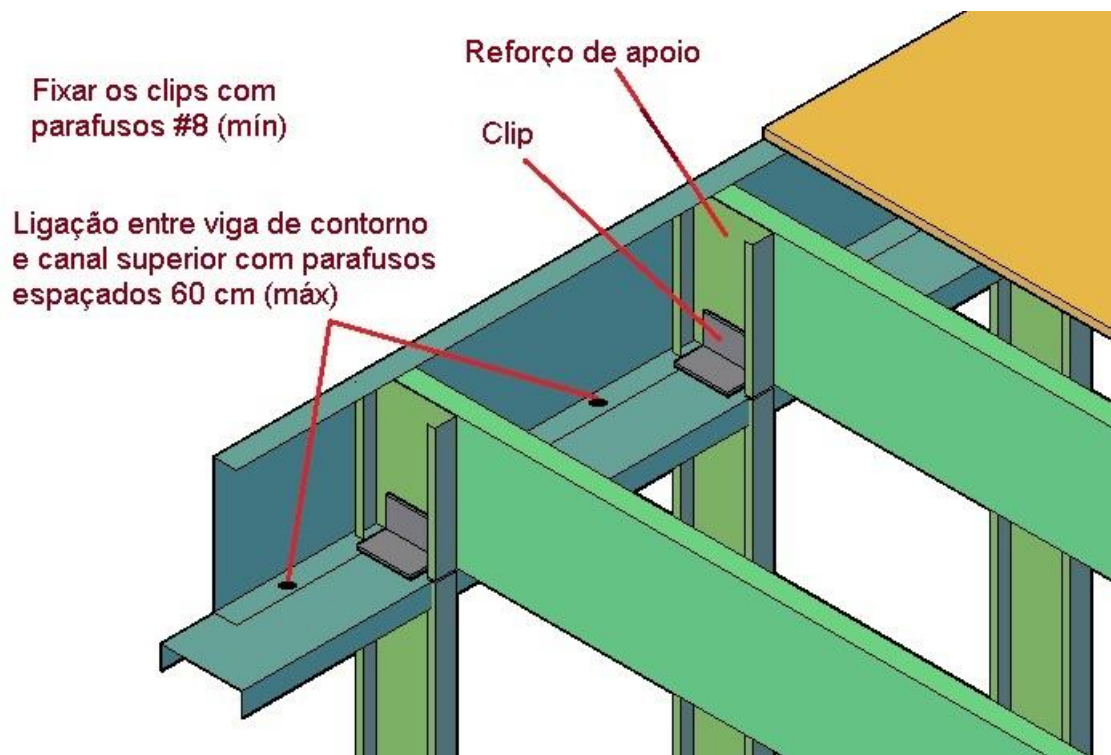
Fixação de pavimento sobre parede estrutural
